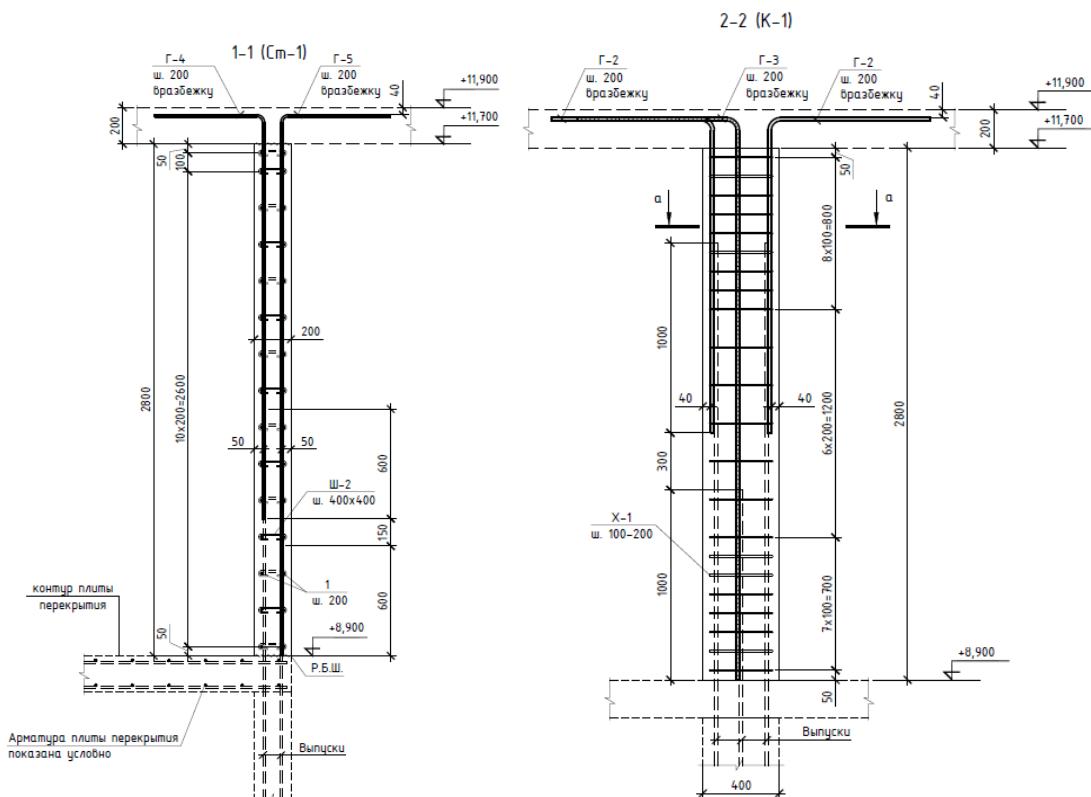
План вертикальных конструкций с отметки +8900 до отметки +11900 (фрагмент проекта)
